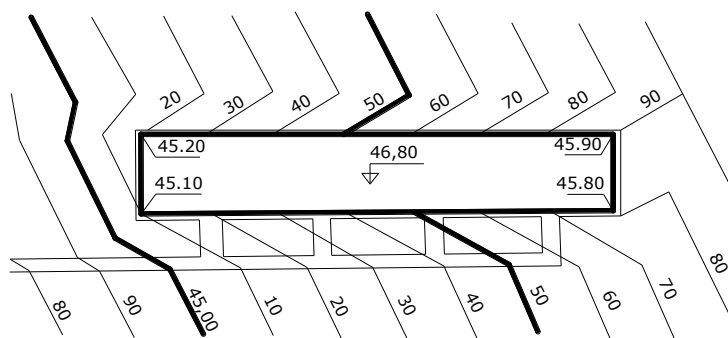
План здания с переменной (нетиповой) высотой цоколя
